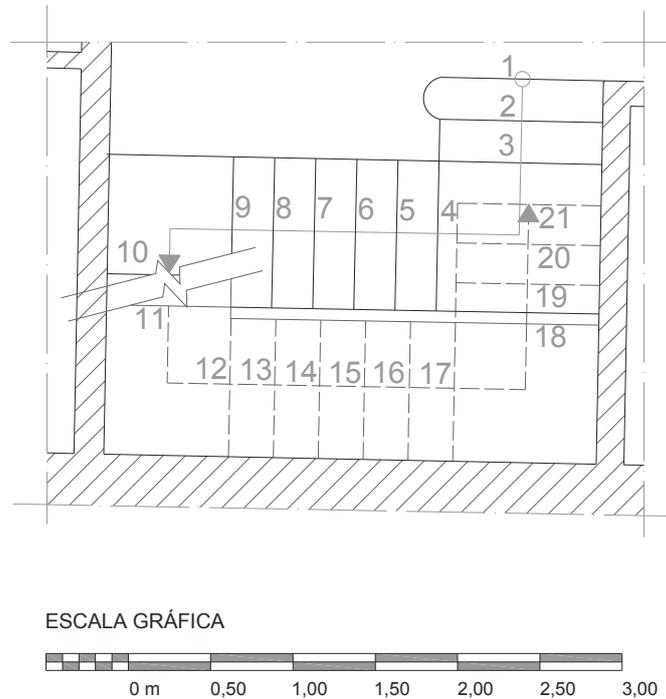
Distribución de la escalera de planta baja a primera
